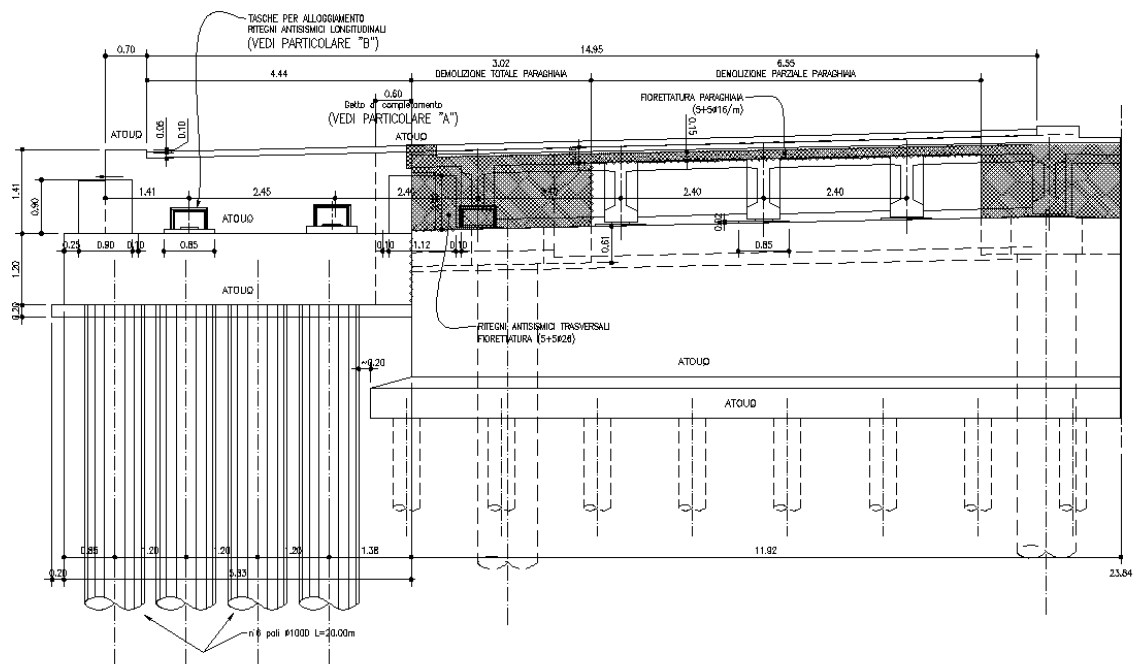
Semi Prospetto spalla con notazione ritegni trasversali
